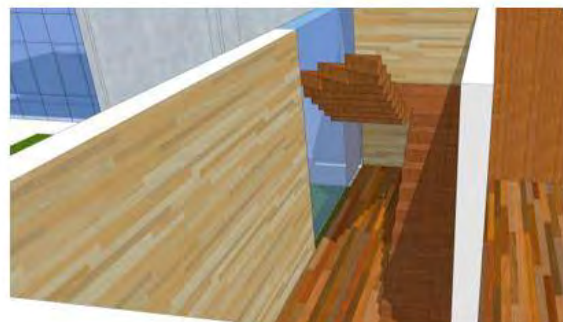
Tatanan Open Plan pada Kantor Lama
